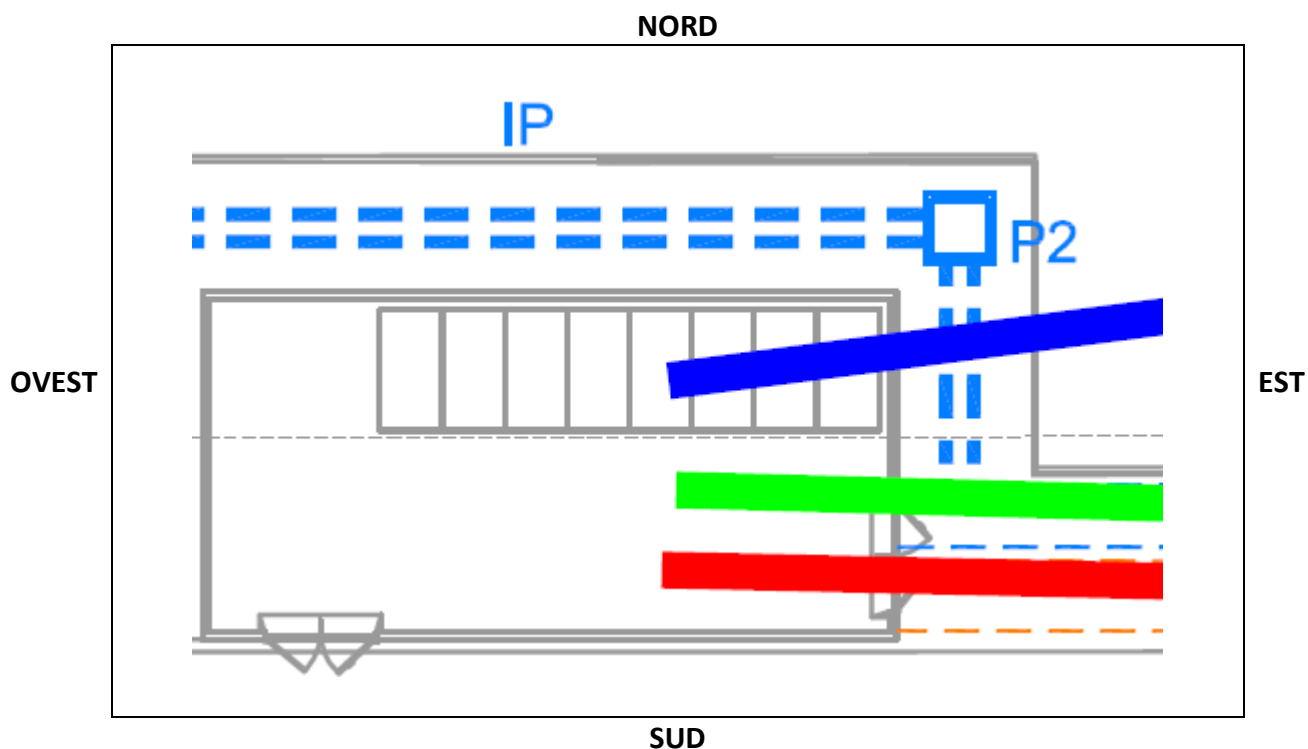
Pianta delle Cabina di Trasformazione CB2
